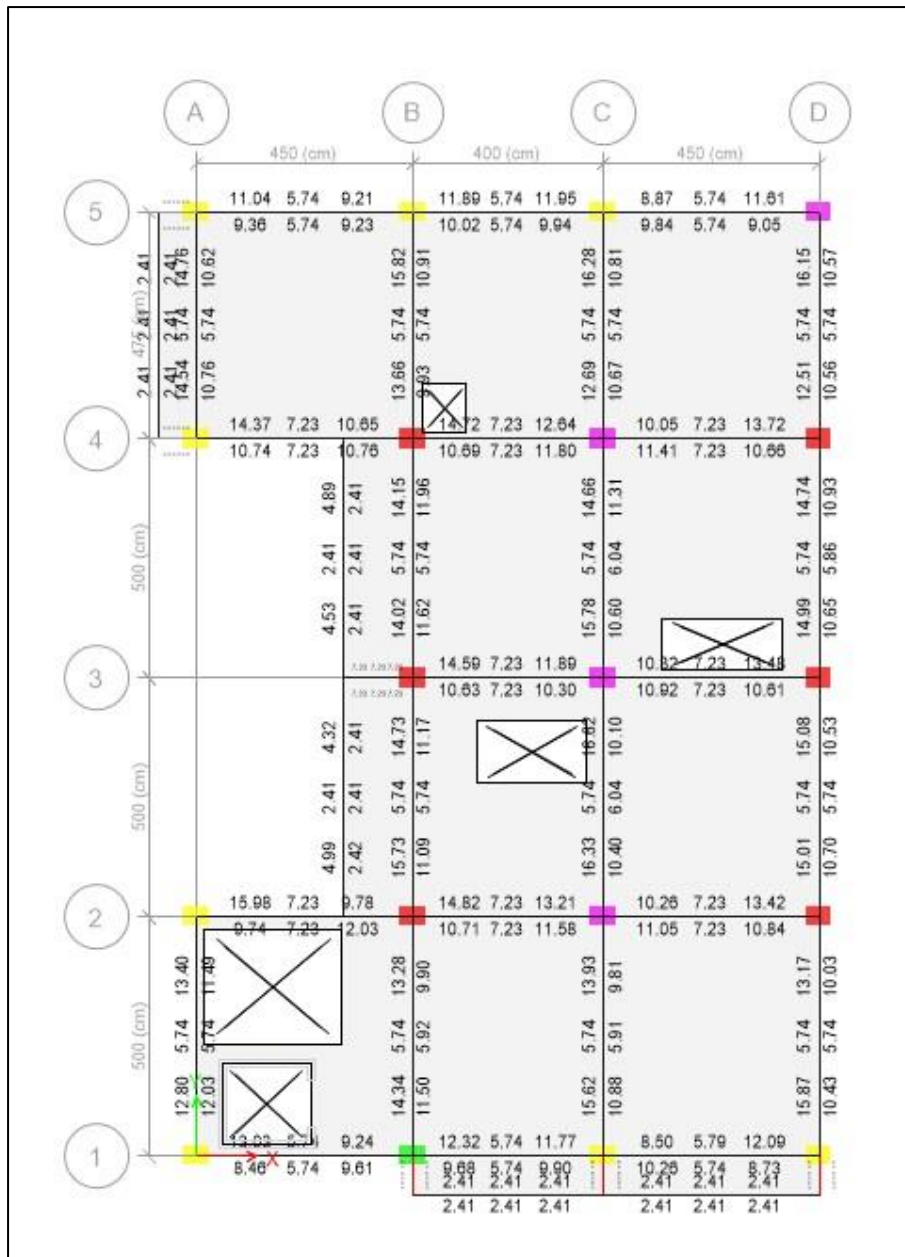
Cálculo de área de acero en vigas y columnas vista en planta
